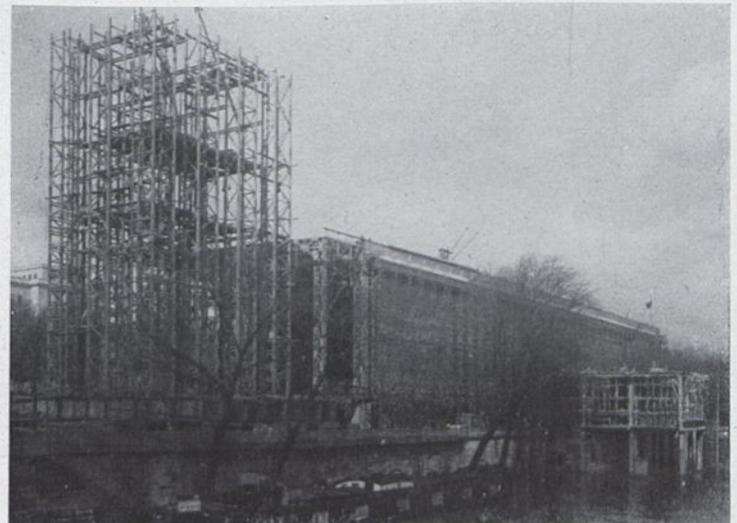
Ausfachung der fertig aufgestellten Hallenkonstruktion und Montage des Turmes.
